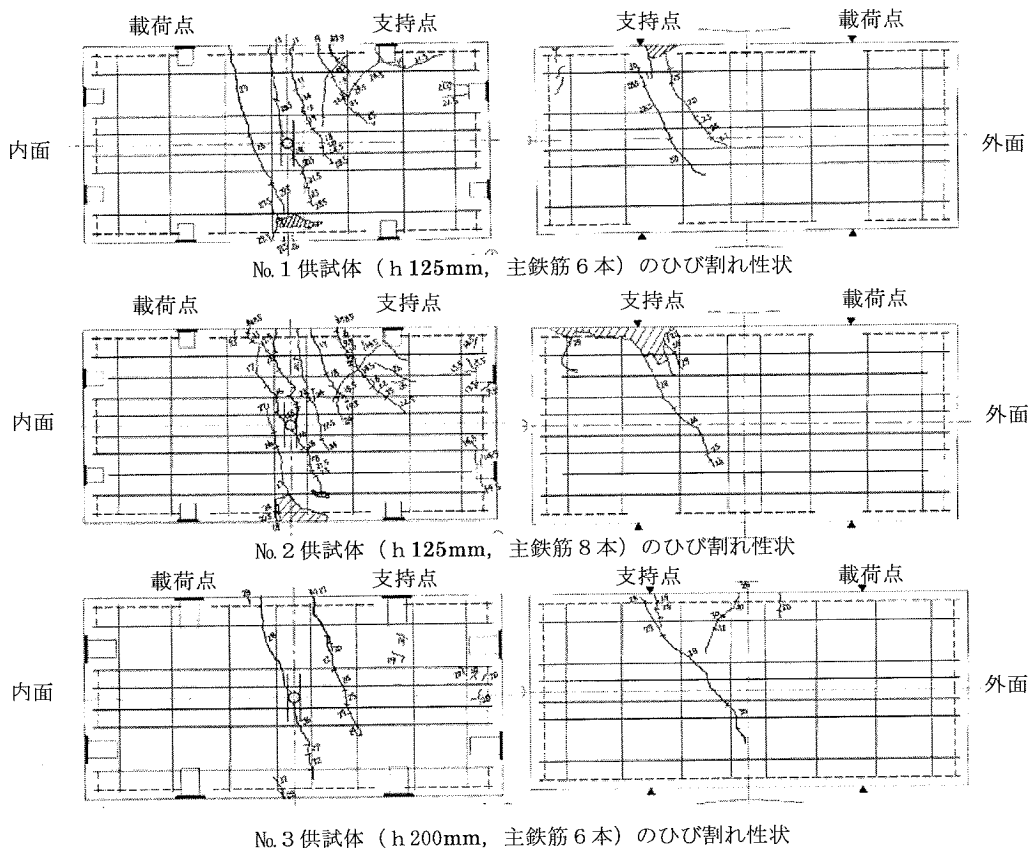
最終破壊時の各供試体のひび割れ状況図
